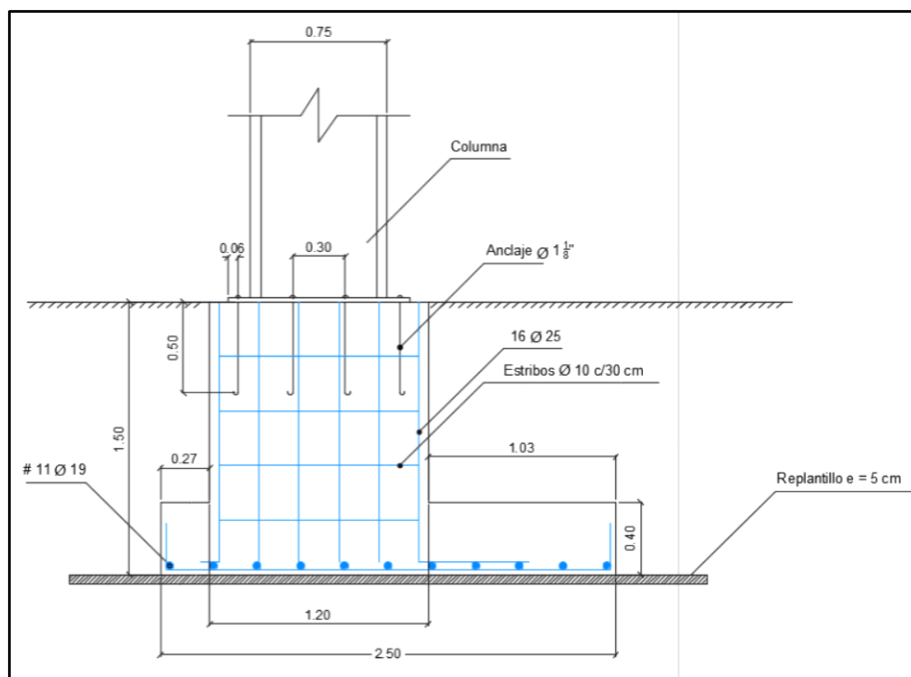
Vista transversal zapata corrida [Pelayo & Ashby, 2020]
